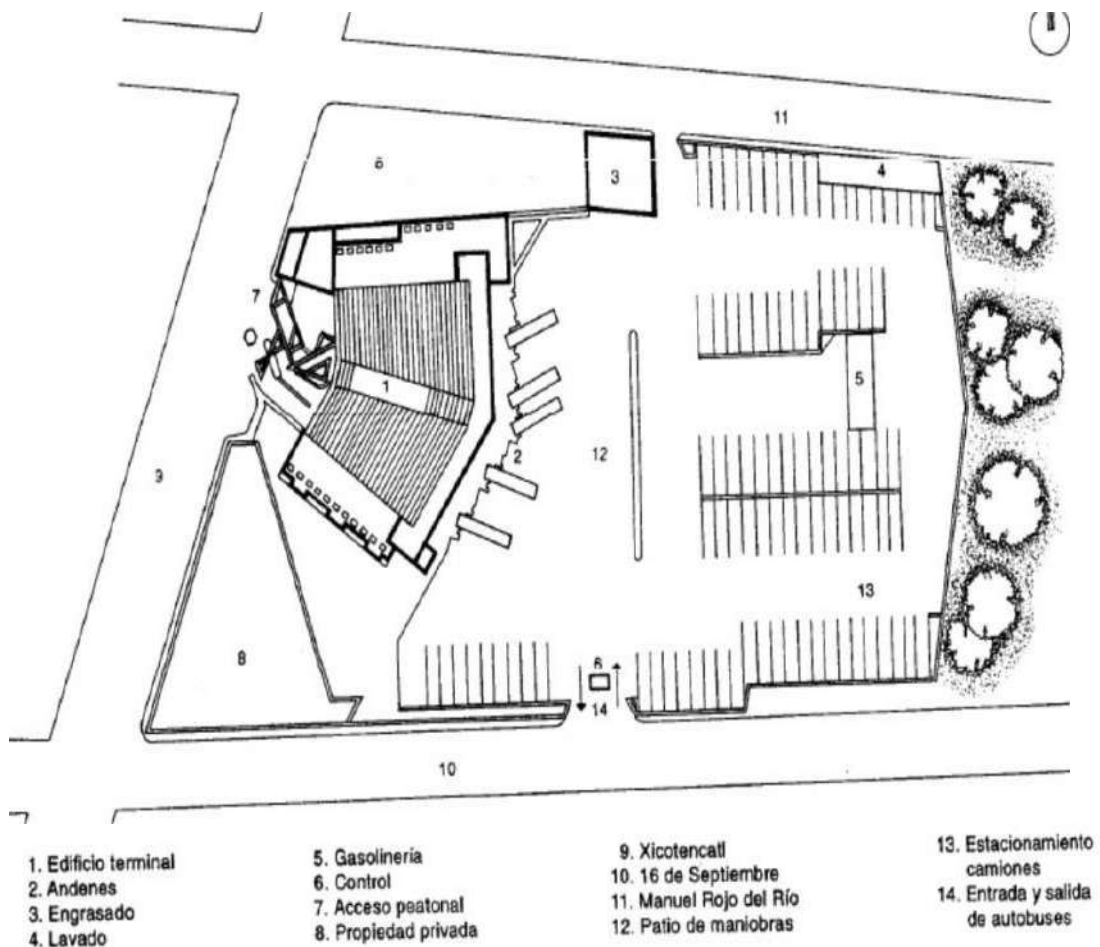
Planta general de transporte federal de pasajeros – México – 1985 (Alfredo Plazola, 2001).
